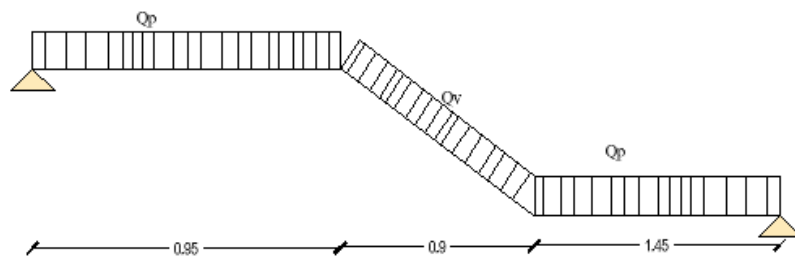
Schéma statique de La coupe B-B (escalier 1)
